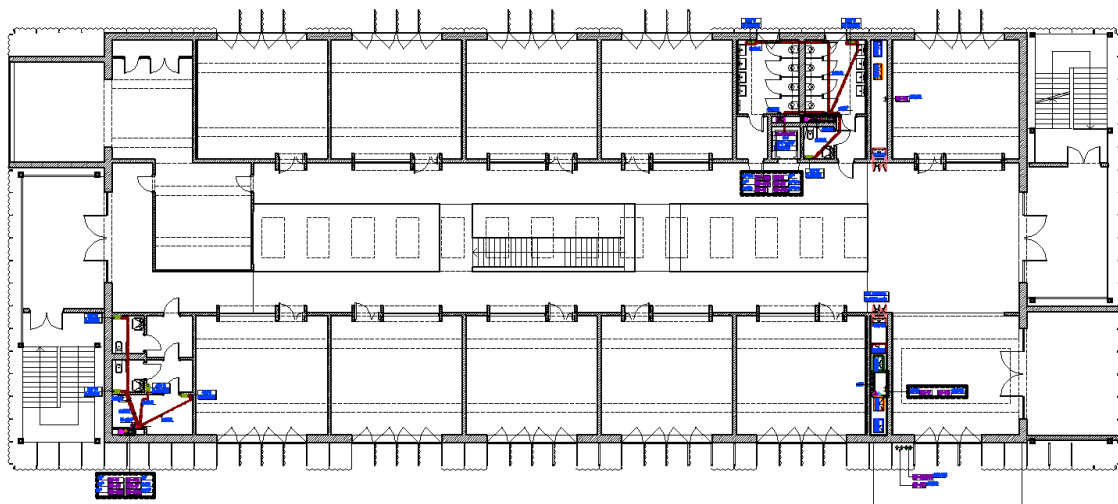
Pianta piano secondo scuola: impianto termico in progetto
